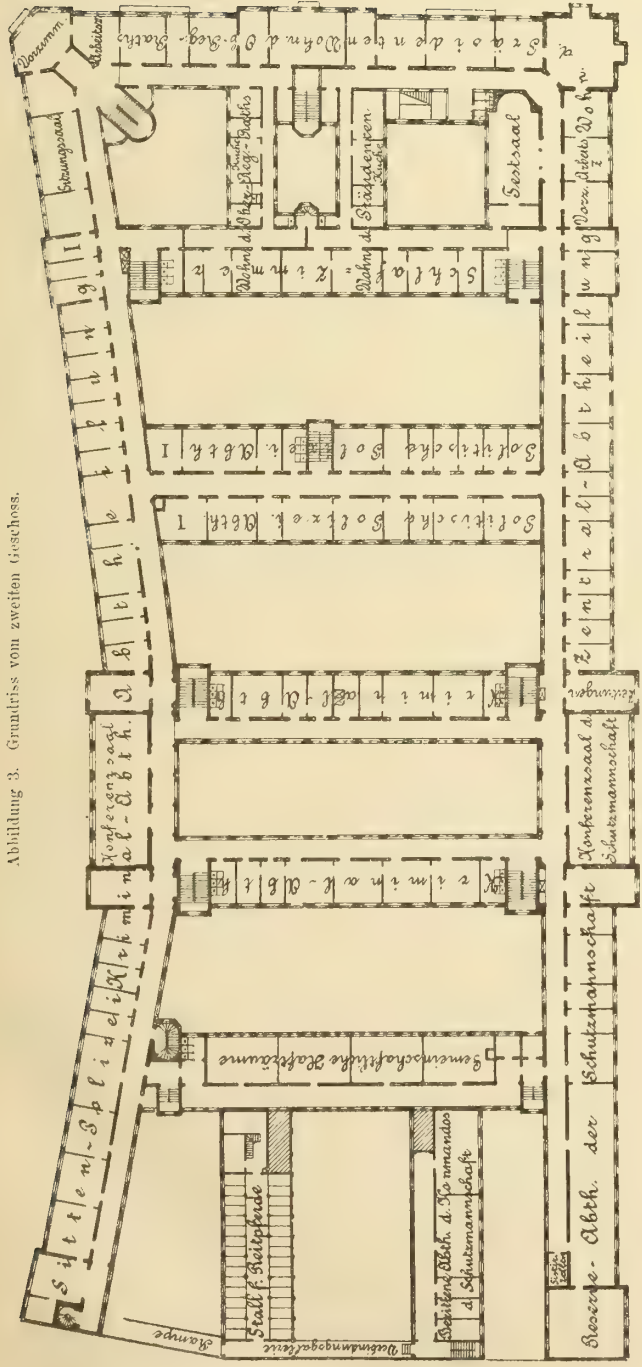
Grundriss vom zweiten Geschoss.
